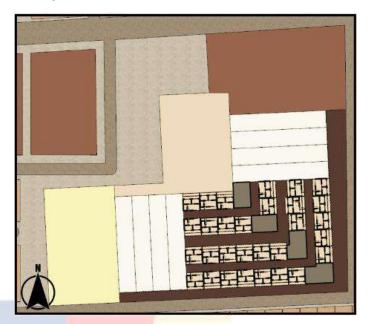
Denah Lantai 3 Gubahan Massa 2
